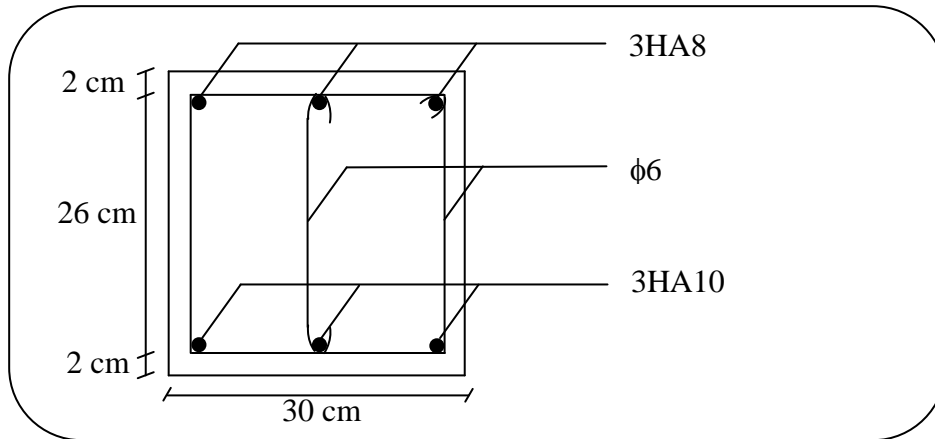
Schéma de ferrailage du chaînage 1
